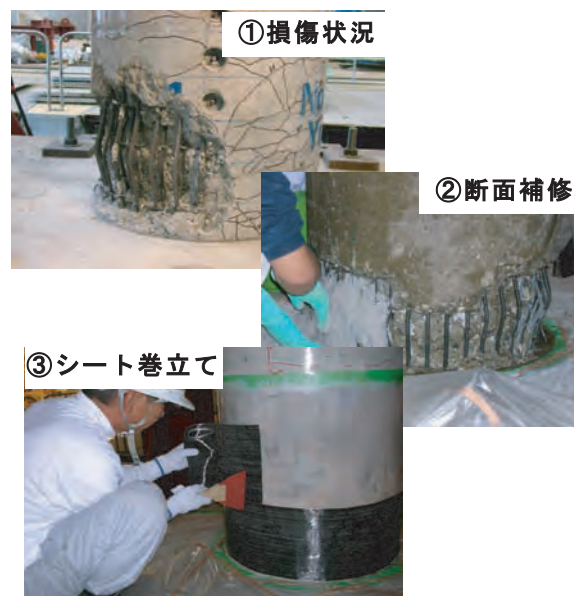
鉄筋コンクリート橋脚の迅速応急復旧
